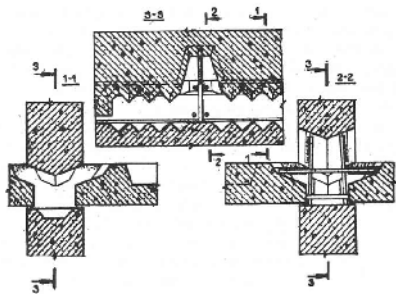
Пример конструкции шпунтового горизонтального платформенного стыка панелей стен и перекрытий сейсмостойкого здания
